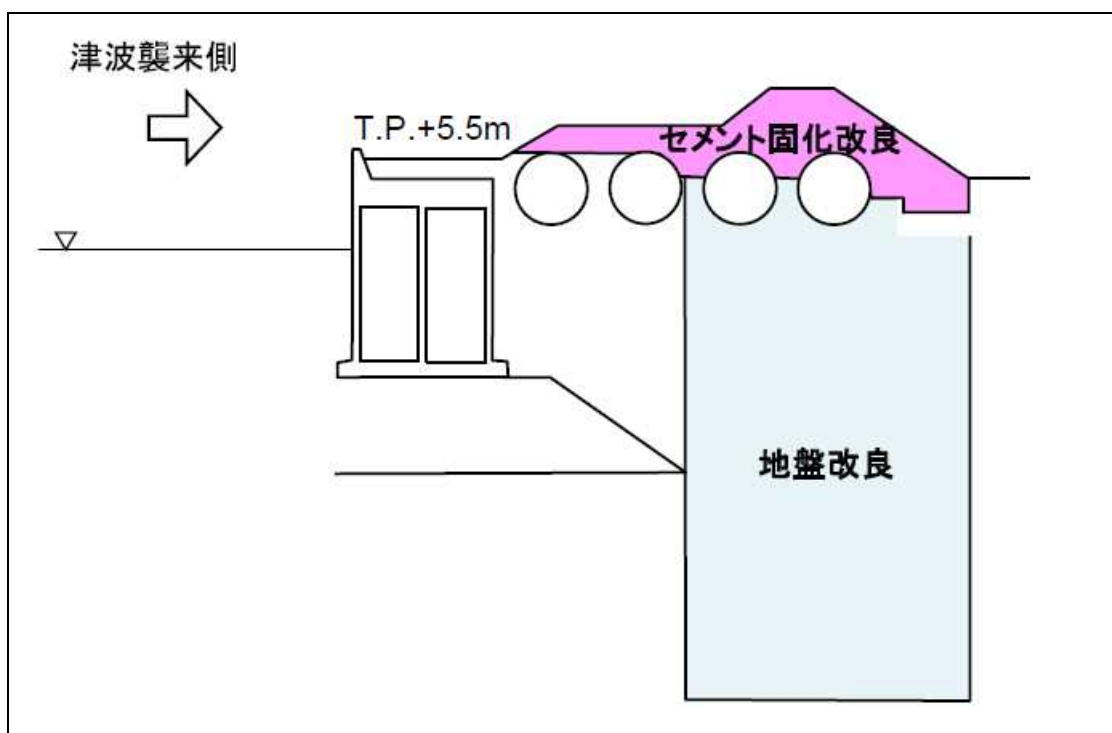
地盤改良部断面図 (関西電力 高浜 1, 2 号炉)
